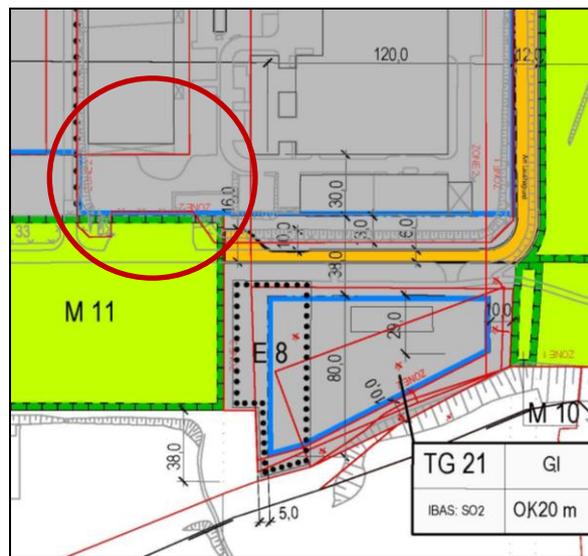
Ausschnitt aus der Planzeichnung, 4. Änderung
